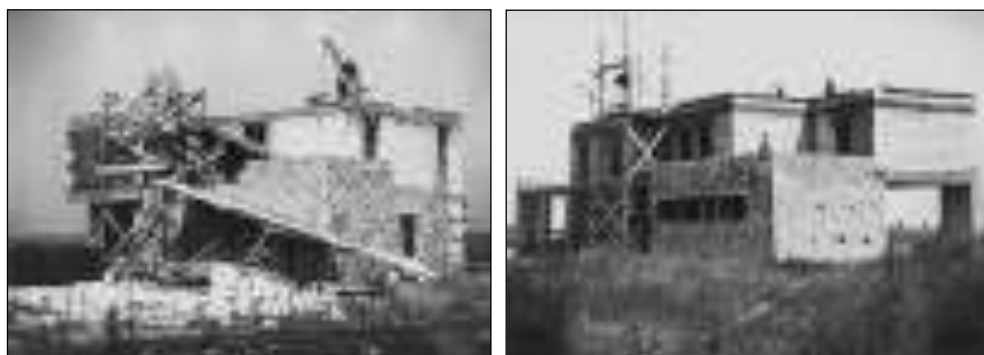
e 7.23 - *Campagne del Metapontino su SS 175 (MT) - Edificio prefabbricato: fondazione e dettaglio pannelli prefabbricati - Archivio Buonsanti
